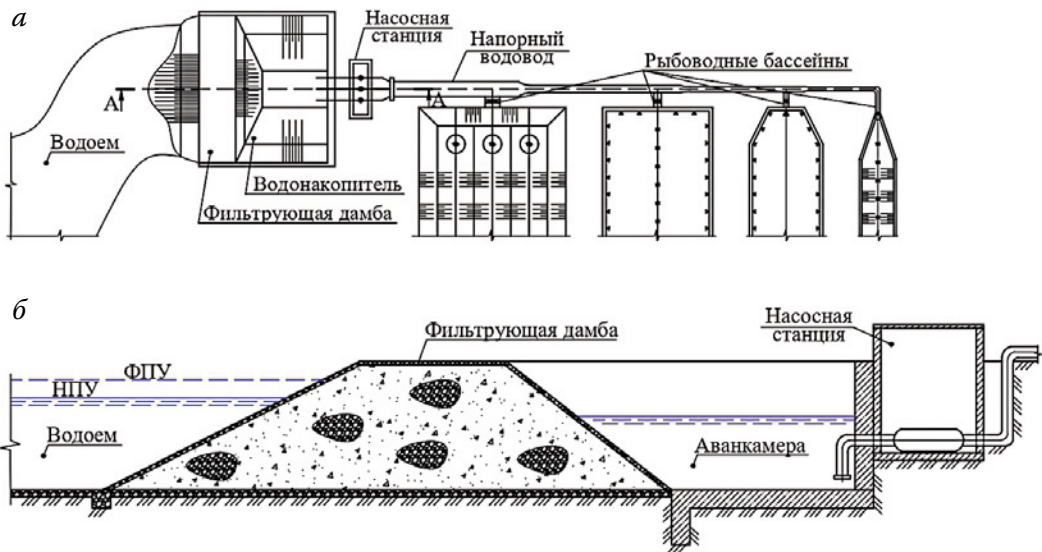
Схема системы водного питания на базе фильтрующей дамбы: *а* – план системы водообеспечения; *б* – продольный разрез по водозабору.
